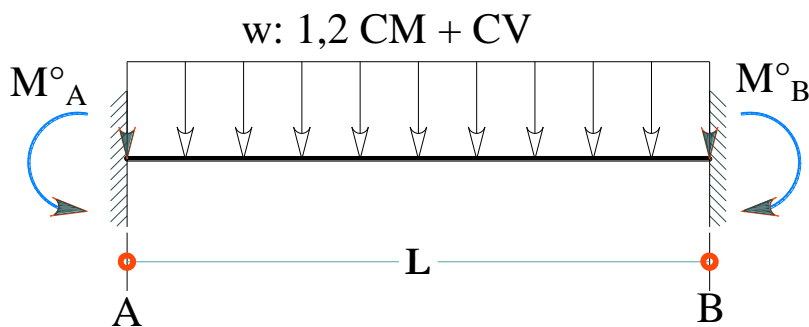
Esquema de cálculo de la fuerza cortante en vigas
